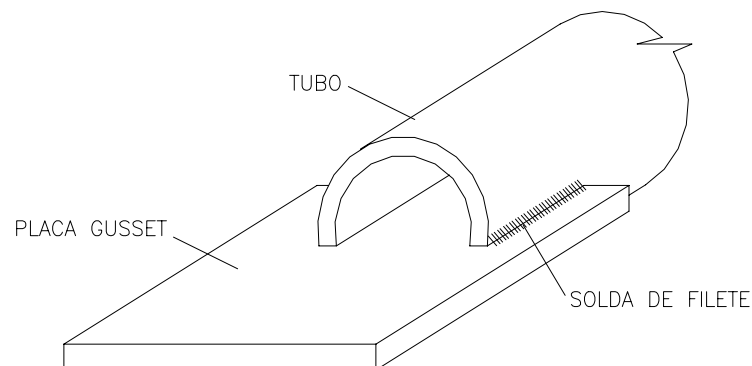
Perfil tubular com ligação soldada.
